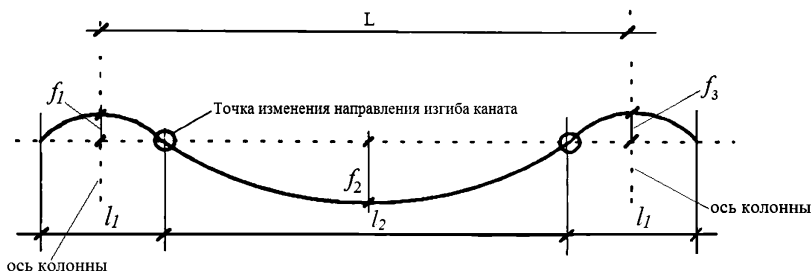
Профиль раскладки напрягаемых элементов по высоте сечения в пролете и на опорах для равномерно распределенных нагрузок
